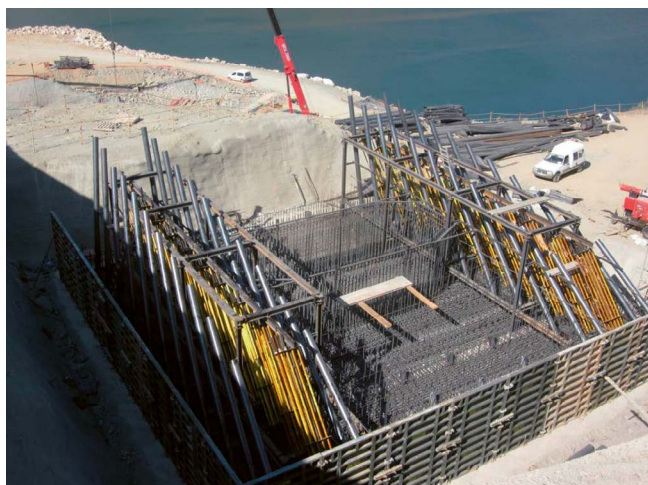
Ejecución de la zapata de retenida de la pila P5 del margen norte.
